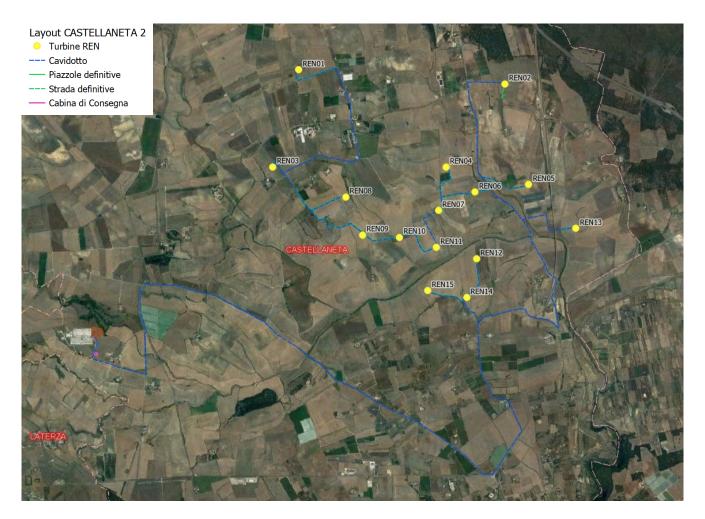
Area di intervento: dettaglio layout di progetto su ortofoto
